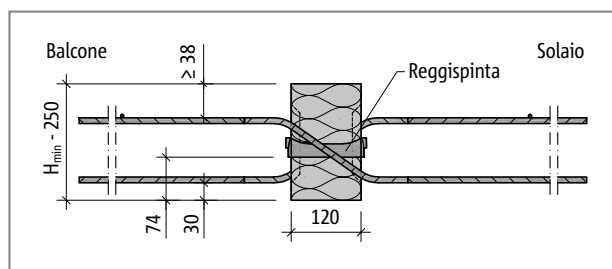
Schöck Isokorb® tipo da QXT70+QXT70 a QXT90+QXT90: sezione dell'elemento
